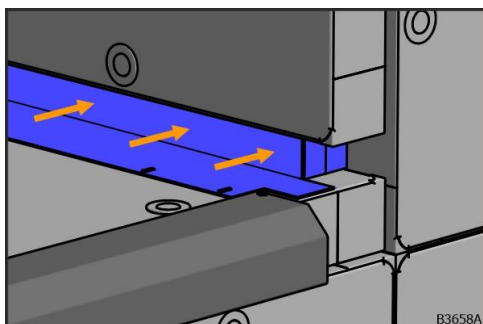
Upevnenie uholníka L-spoja okapovej hrany
